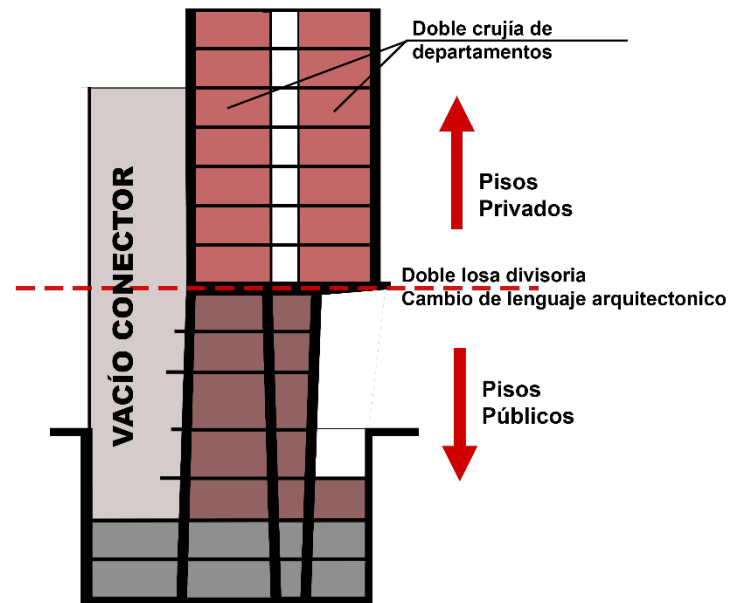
Propuesta en Corte, Losa, vacío y lenguaje arquitectónico
